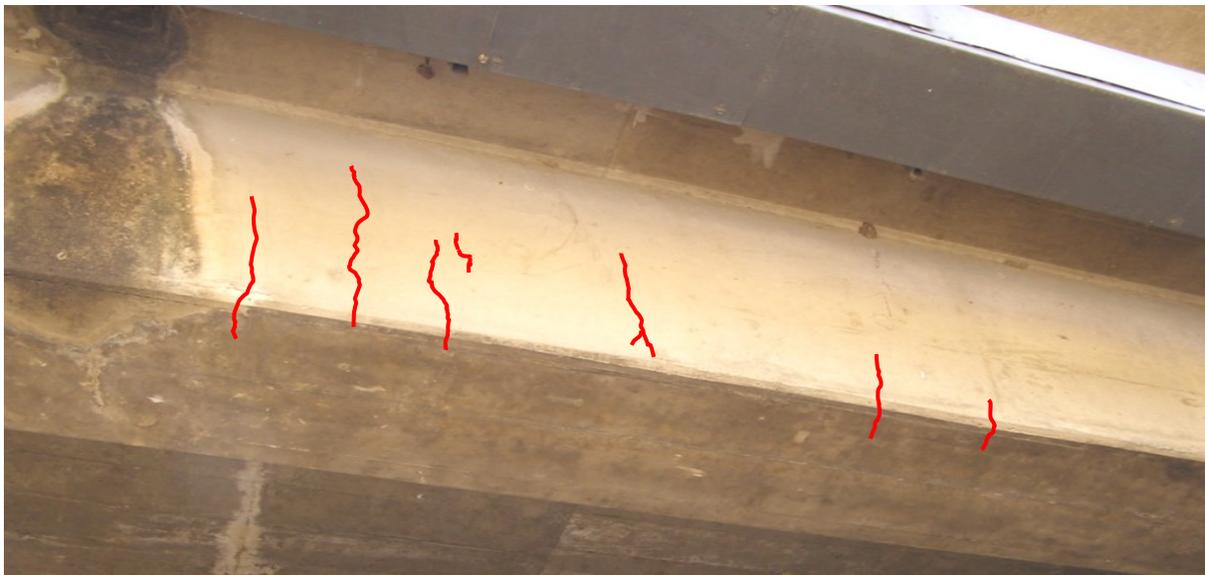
Detalle típico de grietas por flexión en las vigas principales al centro del claro entre la pila 2 y el bastión 2 (detalle típico).
